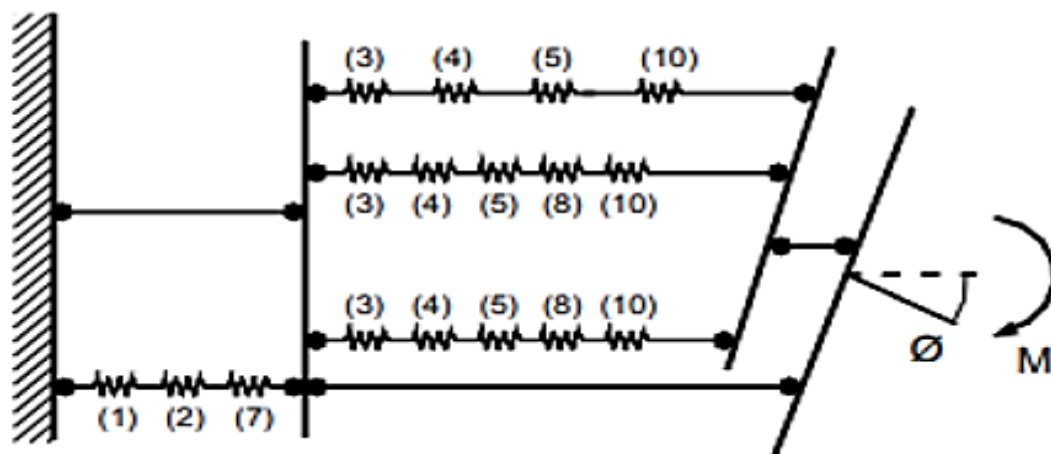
Componentes da ligação viga-coluna representado em molas (Lima, 2003).
